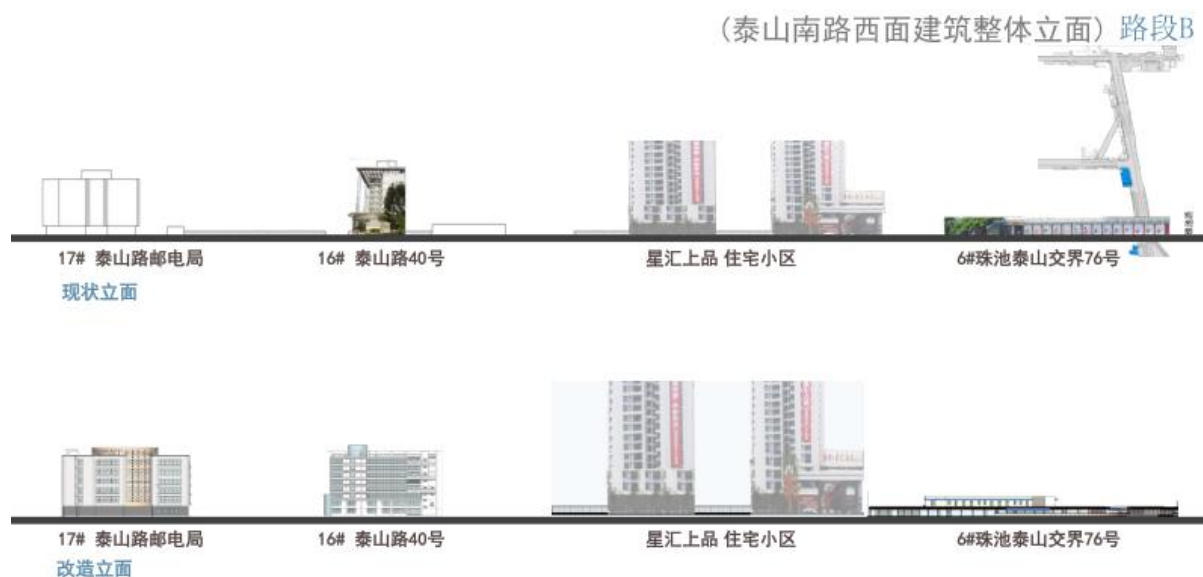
路段 B（泰山南路西侧）建筑改造立面图
